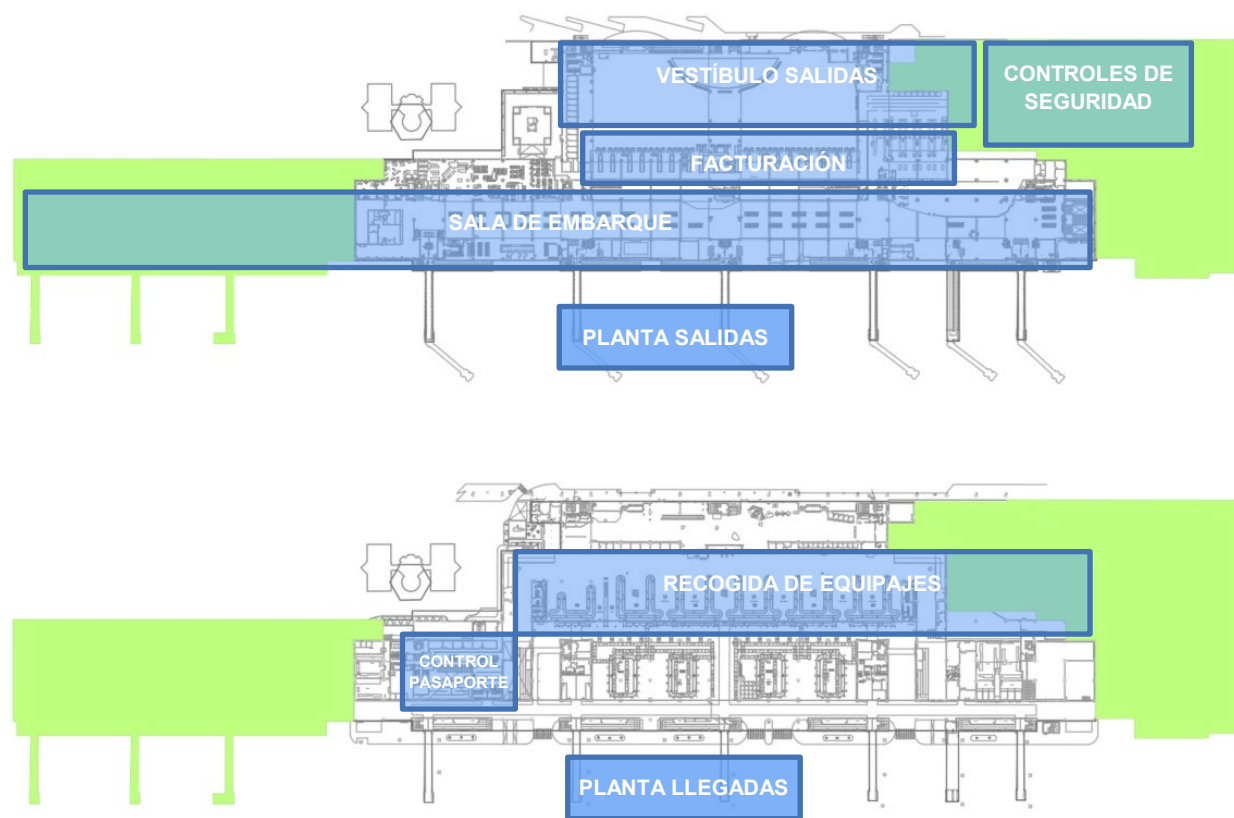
Ampliación del Edificio terminal T1. Planta Salidas y Llegadas
